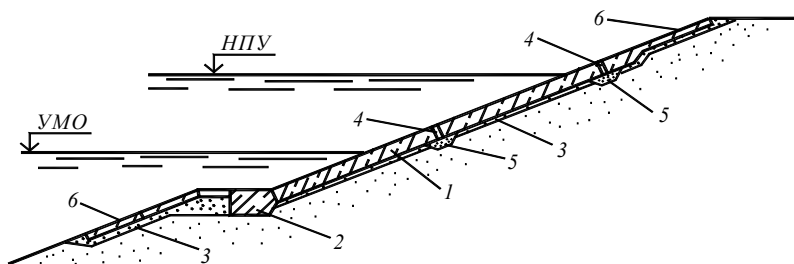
Пример конструкции крепления откоса бетонными плитами:
